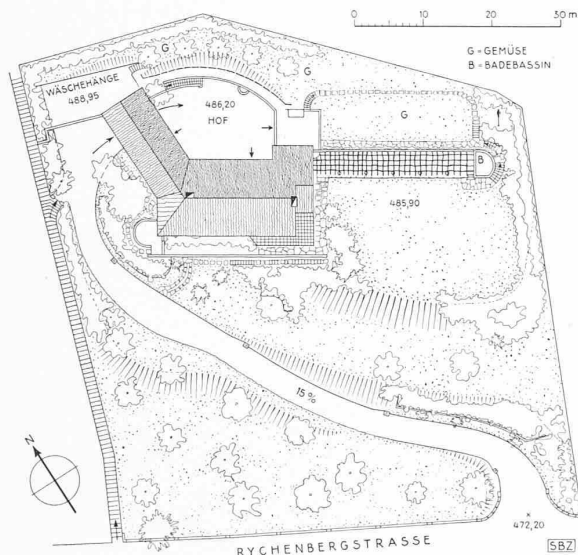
Wohnhaus P. B.-R. in Winterthur. — Lageplan 1:1000
